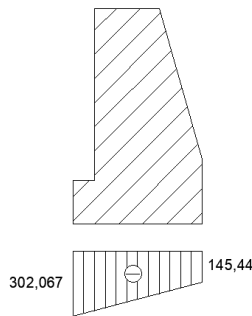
Эпюра крайевых напряжений в грунте подошвы стенки
